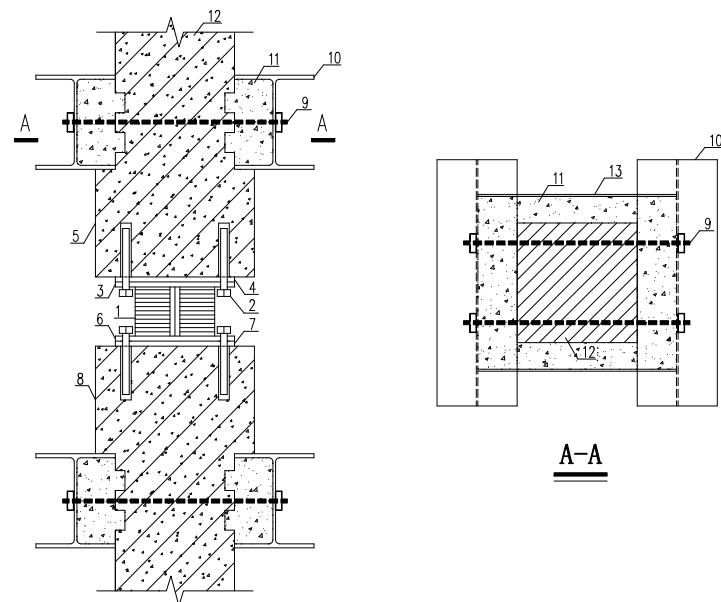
型钢混凝土框架柱托换及隔震支座安装示意图
